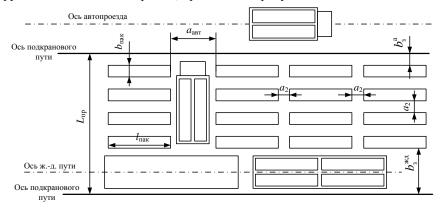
Расчетная схема для определения параметров открытого склада для тяжеловесных грузов с использованием мостового крана по методу элементарных площадок
